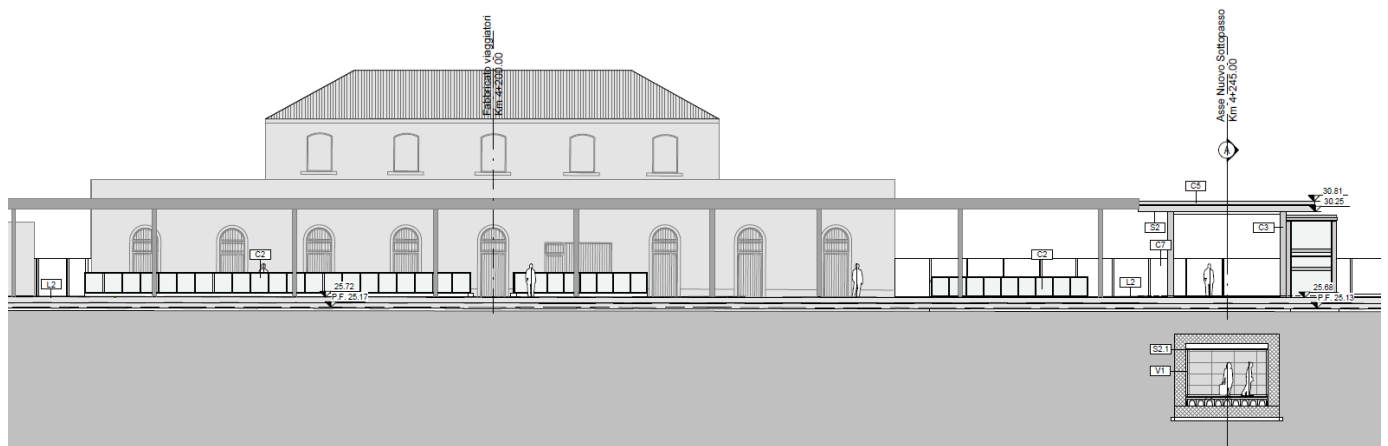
Sezione longitudinale – Sottopassaggio e marciapiede 1° binario
